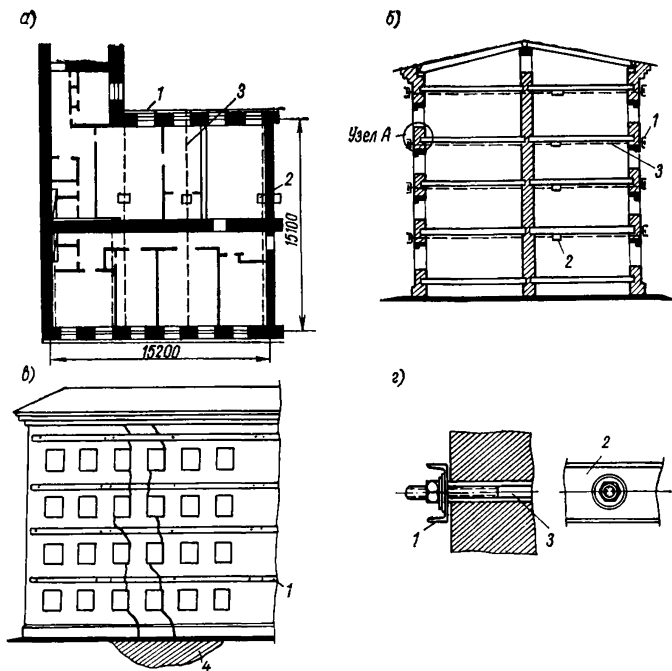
Схема крепления каменных стен накладками и тяжами
